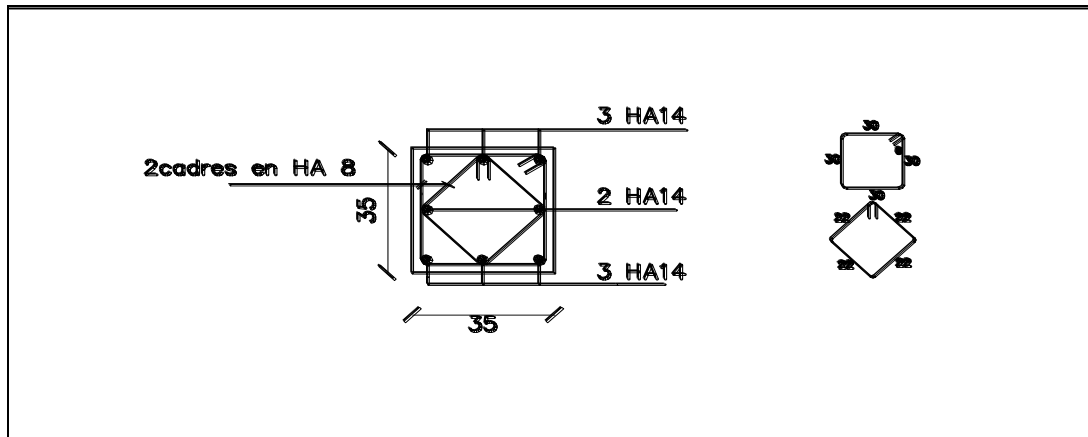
Schéma de ferrailage du poteau 35x35
